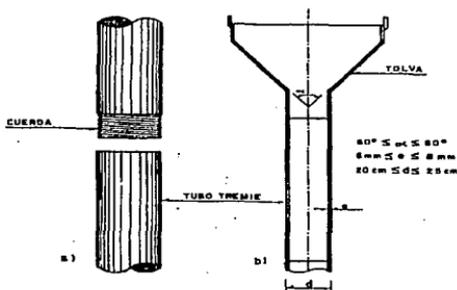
Tubería tremie para colados bajo agua o lodo
